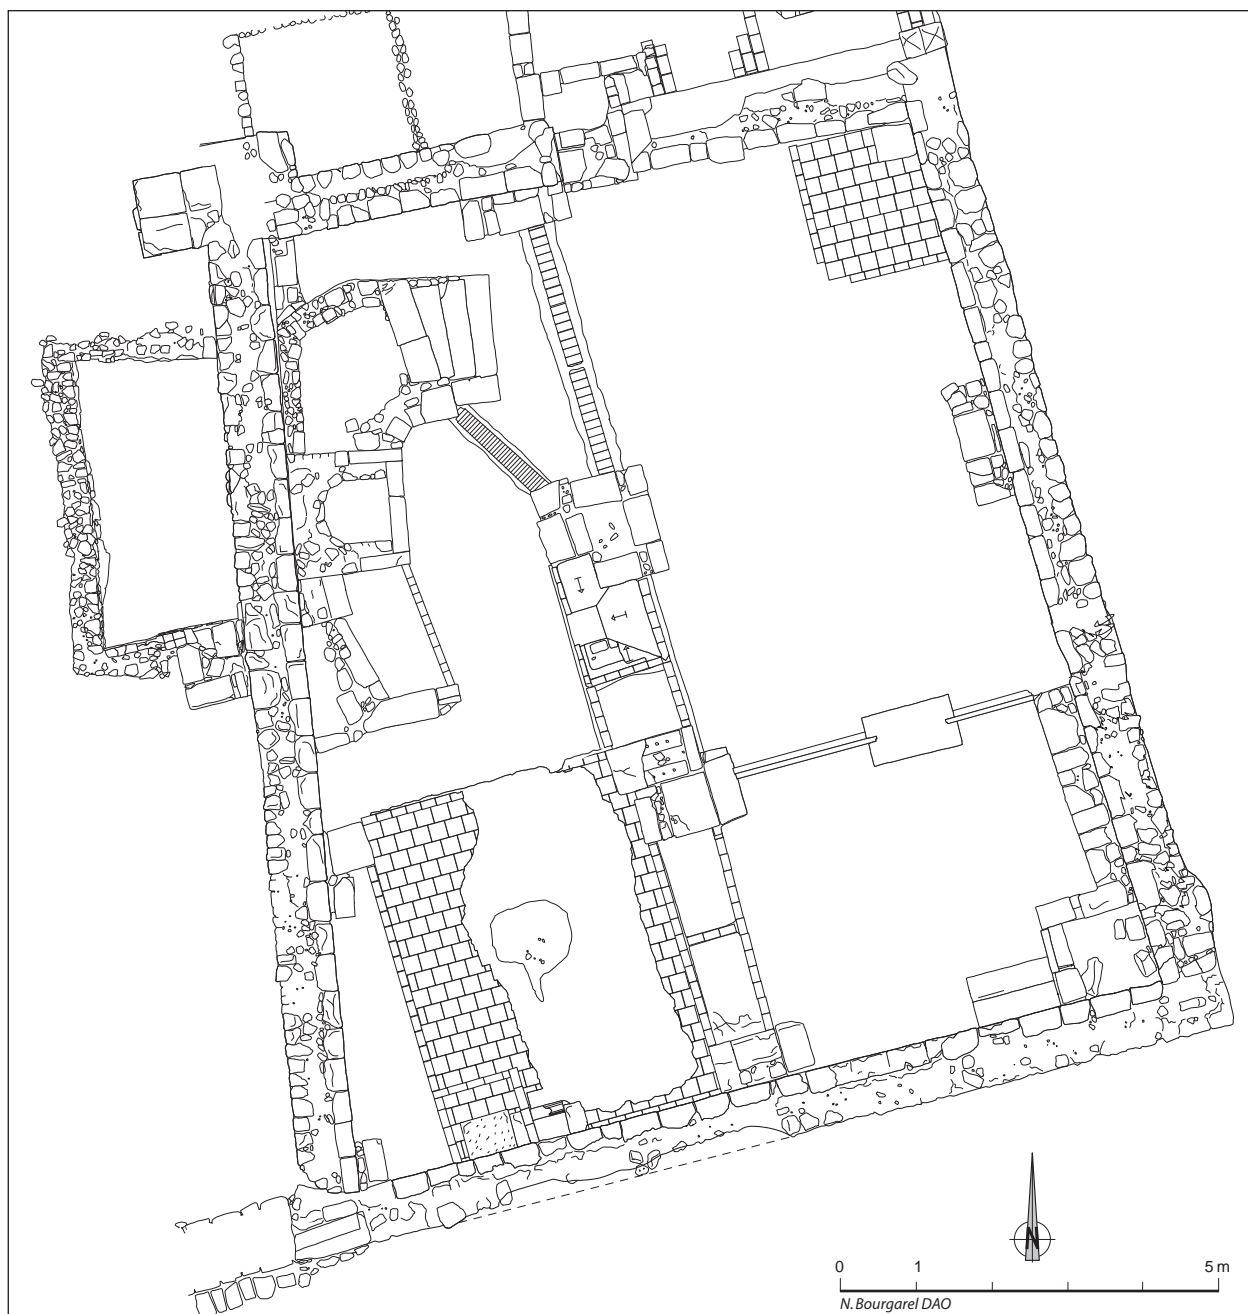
Plan de la cave de la parcelle 384 (DAO N. Bourgarel/Inrap).
